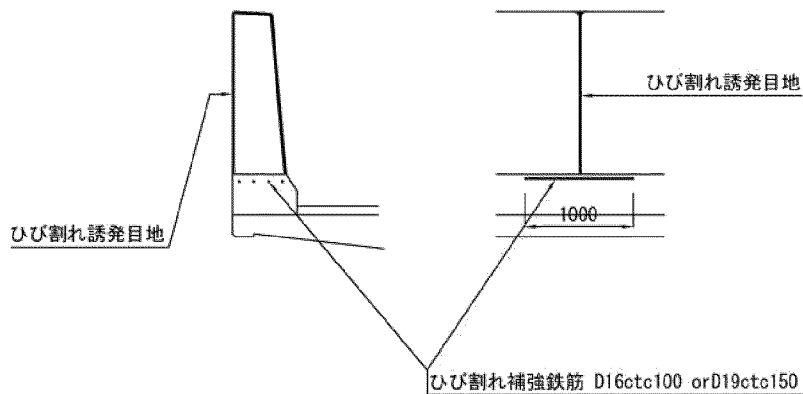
ひび割れ誘発目地部の地覆補強鉄筋
